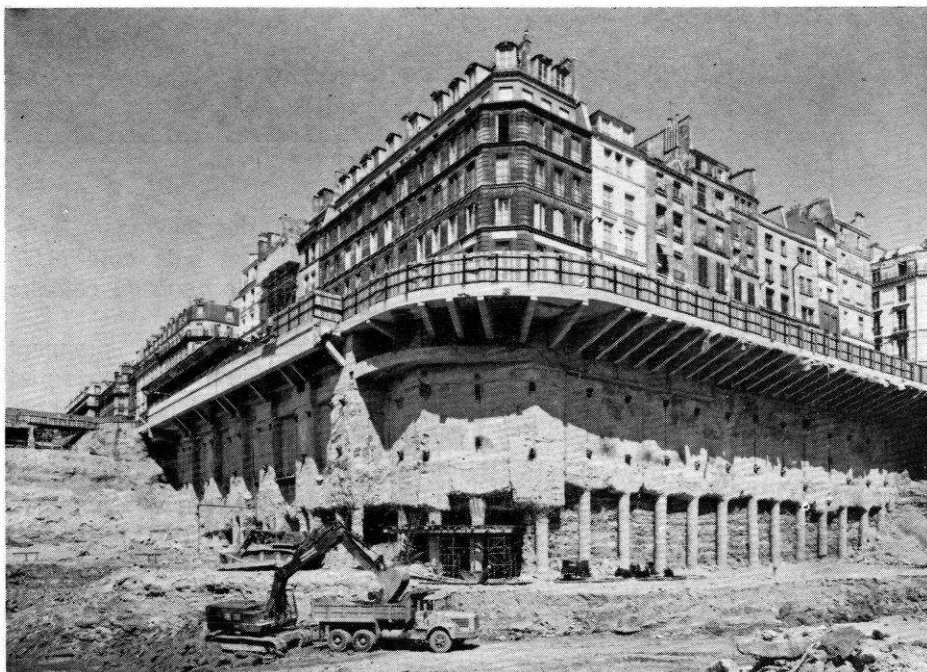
Station Châtelet-Les Halles. Parois montées et terrassement. (Photo Billerach).
